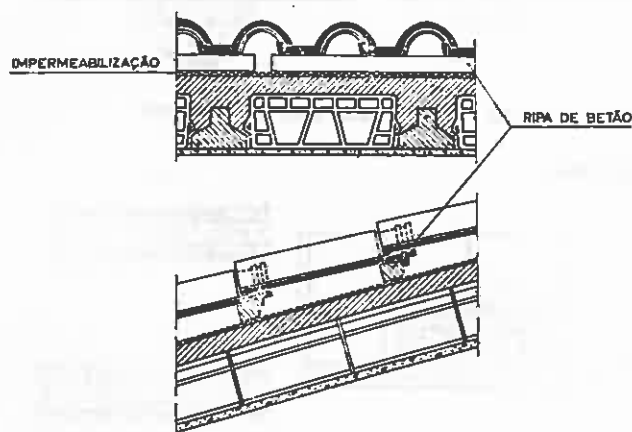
Telha sobre laje inclinada com ripado de betão (19)
